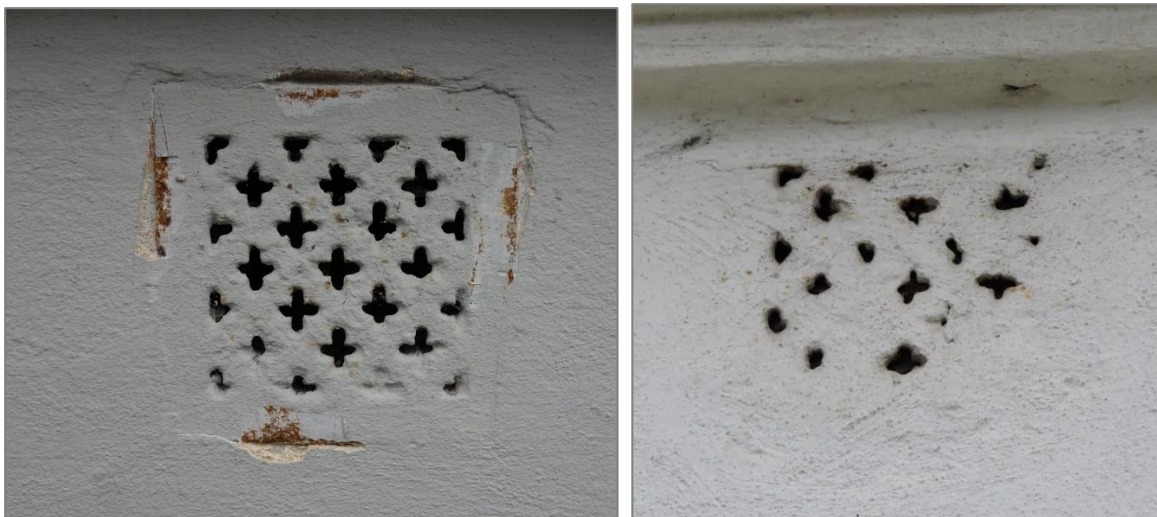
Dawna Oberża, elewacja północna – widok szczegółowy, ubytki i pęknięcia na styku z wyprawą tynkarską.
